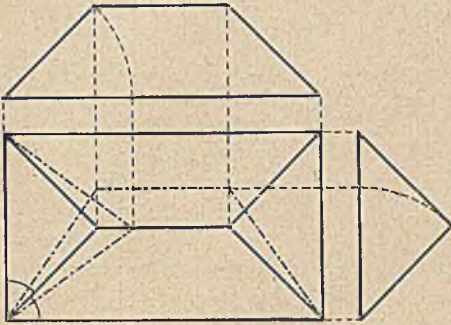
Walmdach. (Alle Dachflächen haben gleiche Neigung).
